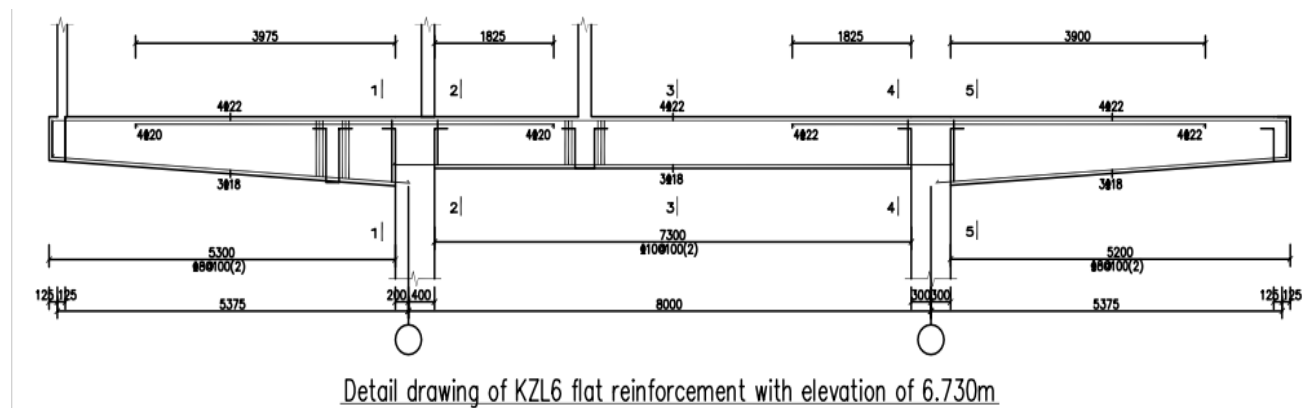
Secção transversal das vigas do pórtico em análise (fonte: projecto estrutural da portagem de Zintava da CRBC)
